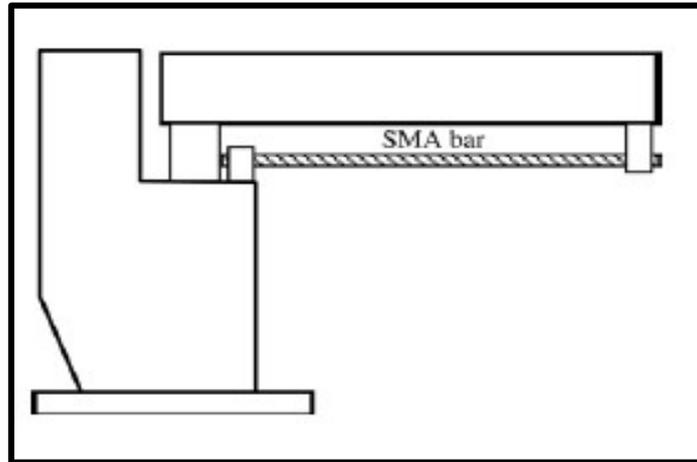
Schéma d'installation d'une barre en AMF sur un pont pour la prévention sismique. (Source : Adoum Waibaye.2016)
